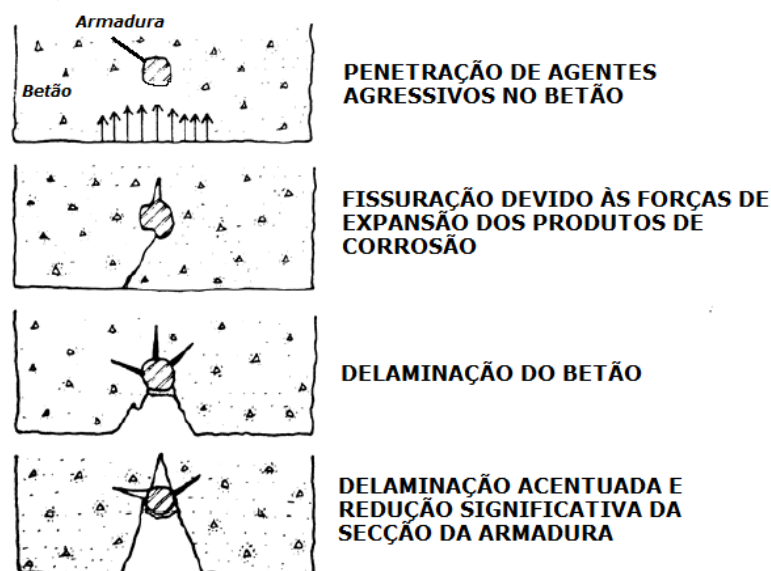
Esquemática de fissuração e delaminação devido à corrosão das armaduras [1]
